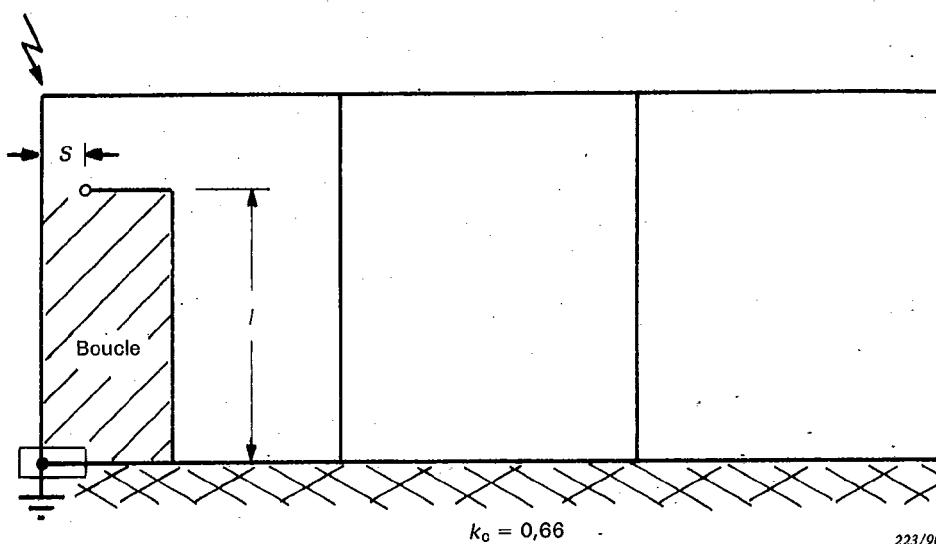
Proximité de l'installation de protection contre la foudre et d'autres installations.
